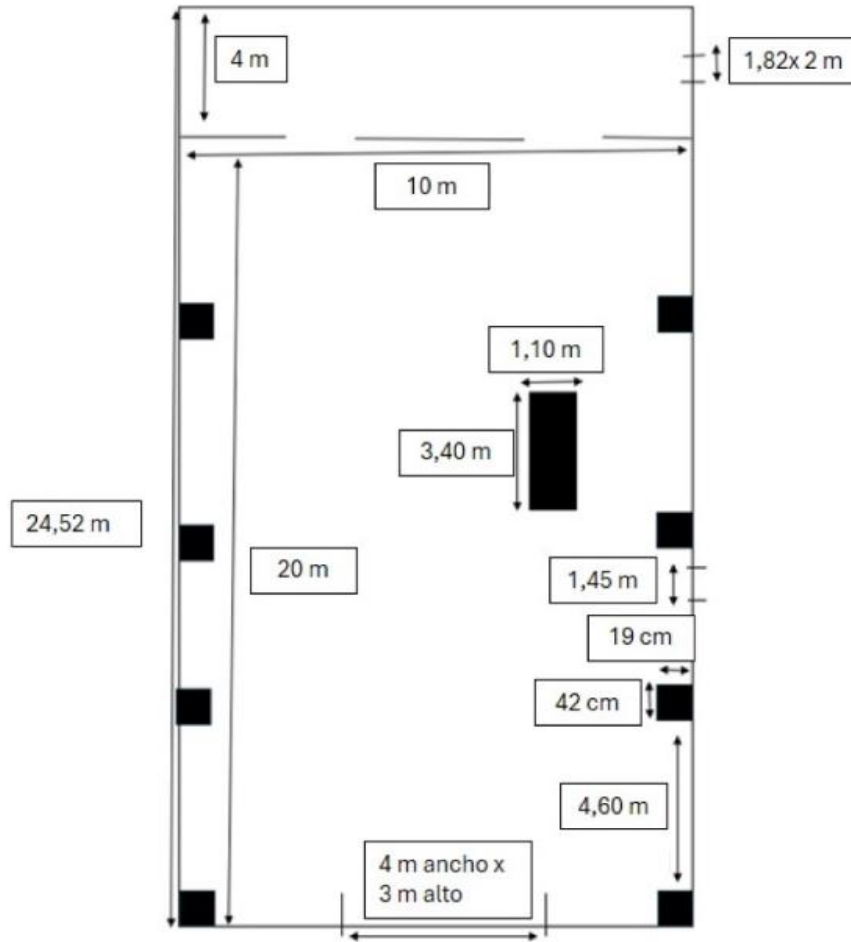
Plano con las medidas del almacén donde se situaría el centro de interpretación. Fuente: elaboración propia.
